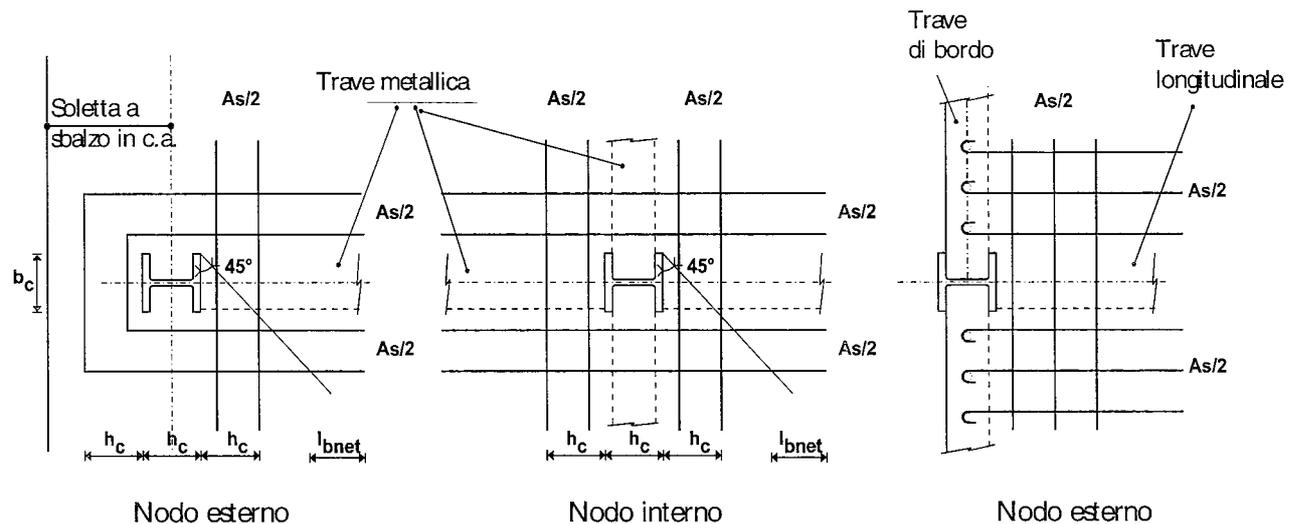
I dettagli di armatura in corrispondenza dei nodi trave-colonna
